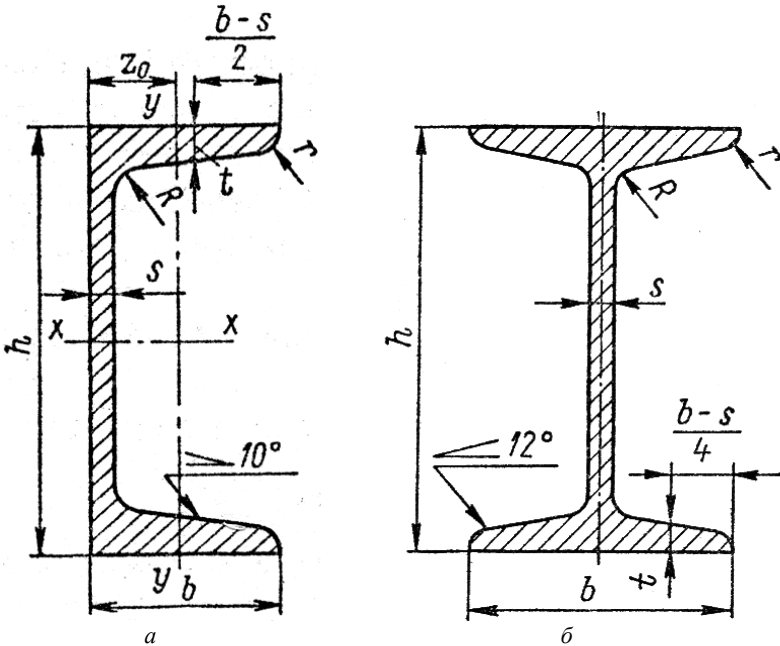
Креслення перерізу [10, с. 391-392]:
